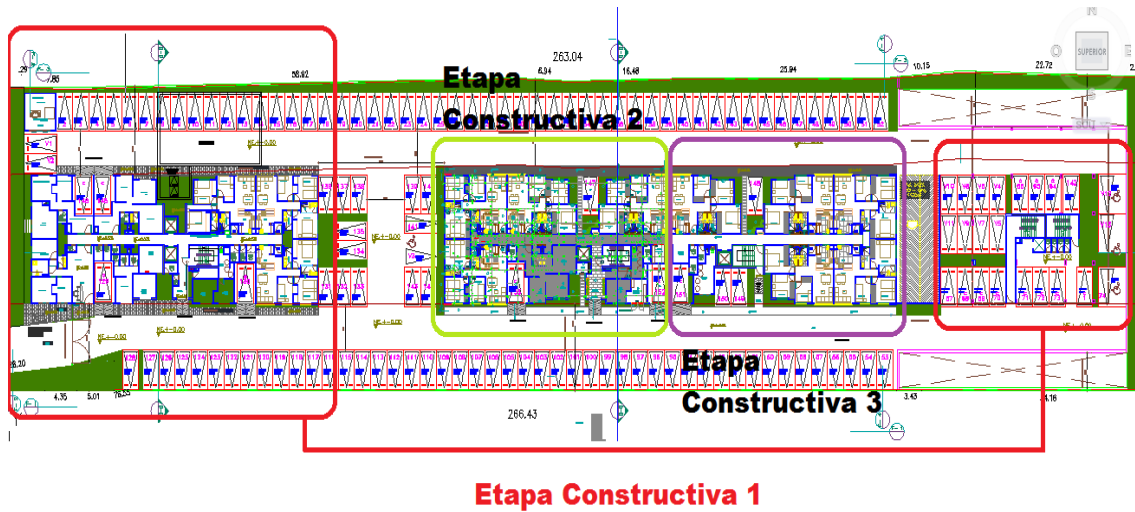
Etapas Constructivas Bosque de Tulipanes – Fuente: Elaboración Propia
